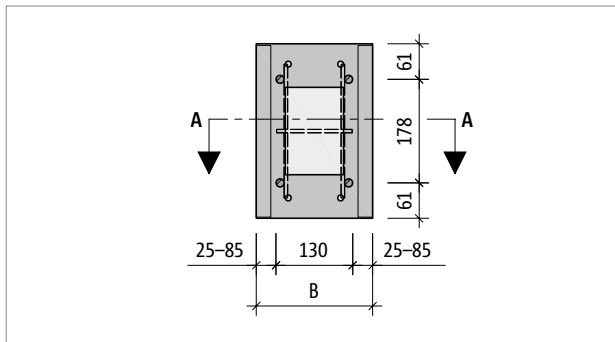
Schöck Sconnex® Typ W-N1T1: Produktgrundriss
